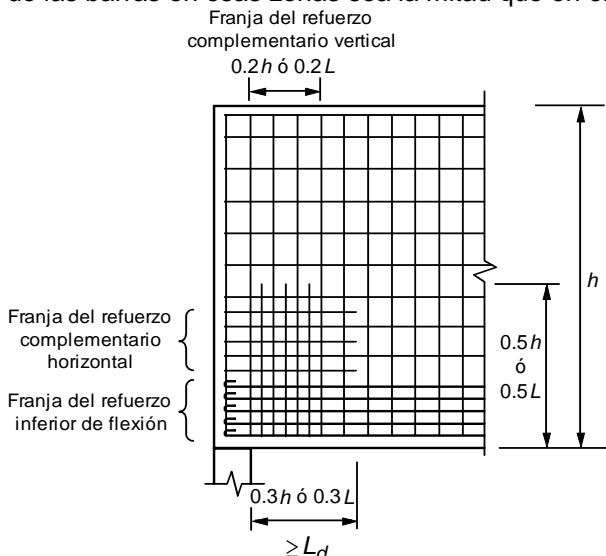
Refuerzo complementario en una zona de apoyo directo de una viga diafragma no atiesada
